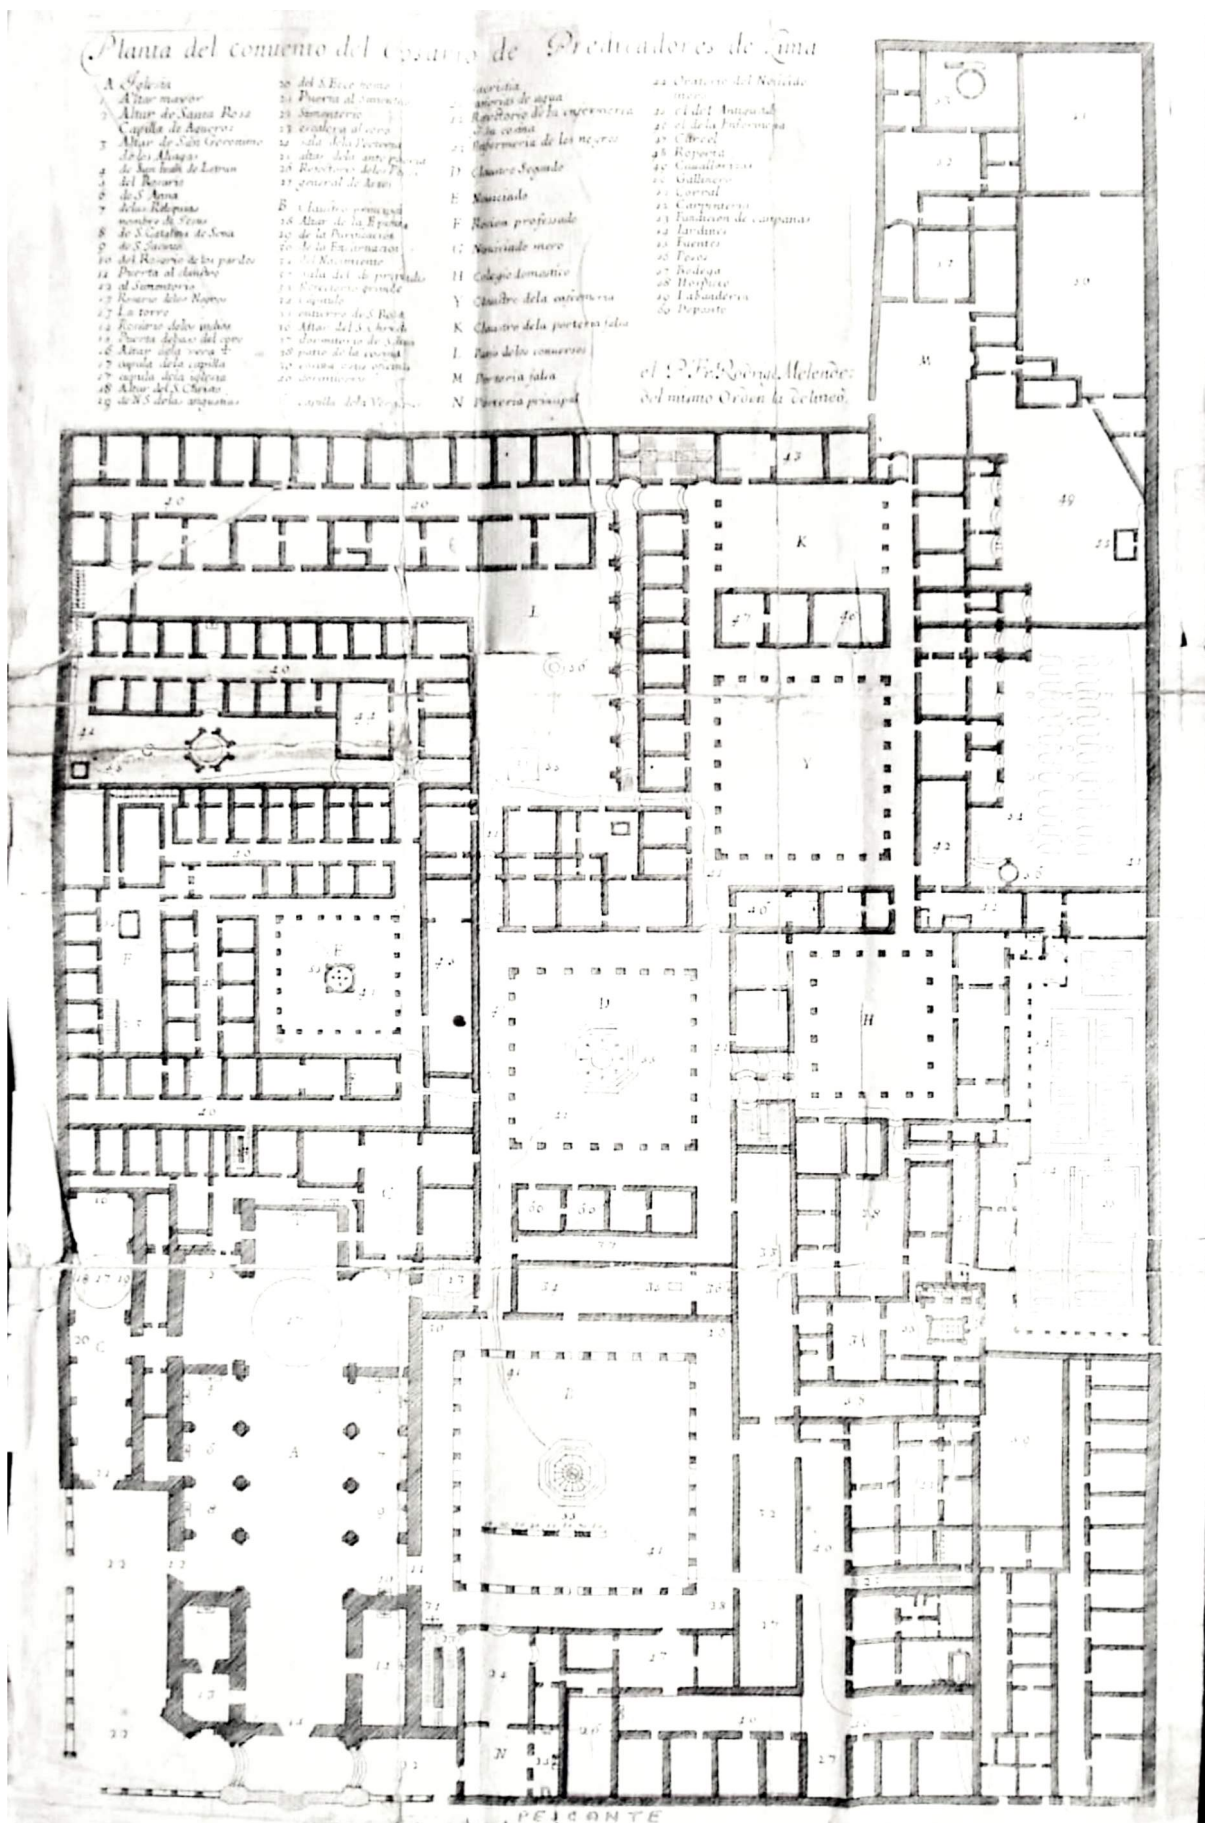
Santo Domingo: Grundriss des Klosters im Jahr 1681. Ouelle: MEL-1681, eigene Reproduktion des Originalplanes in
